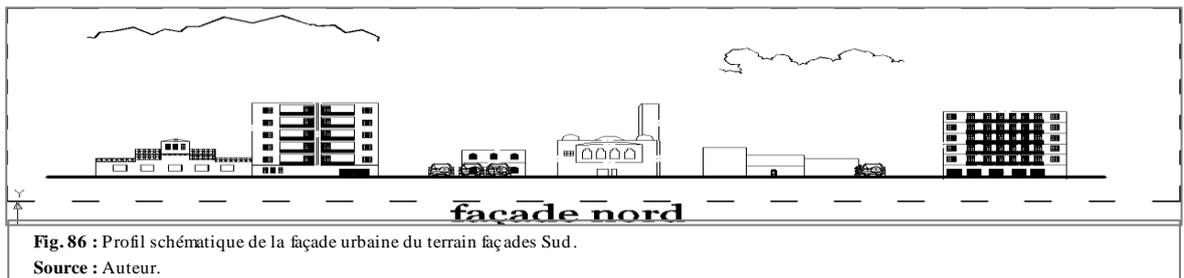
Profil schématique de la façade urbaine du terrain façades Sud.
